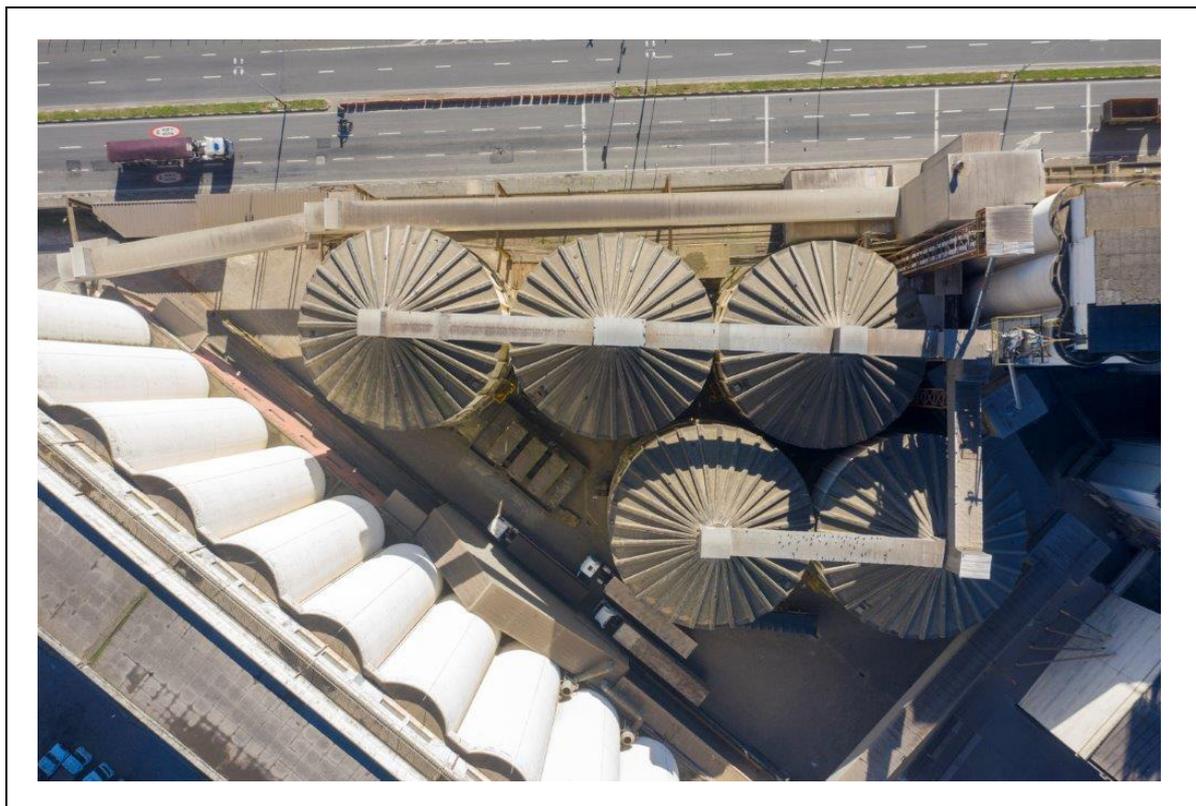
VISTA SUPERIOR DOS SILOS ZORTEA.
